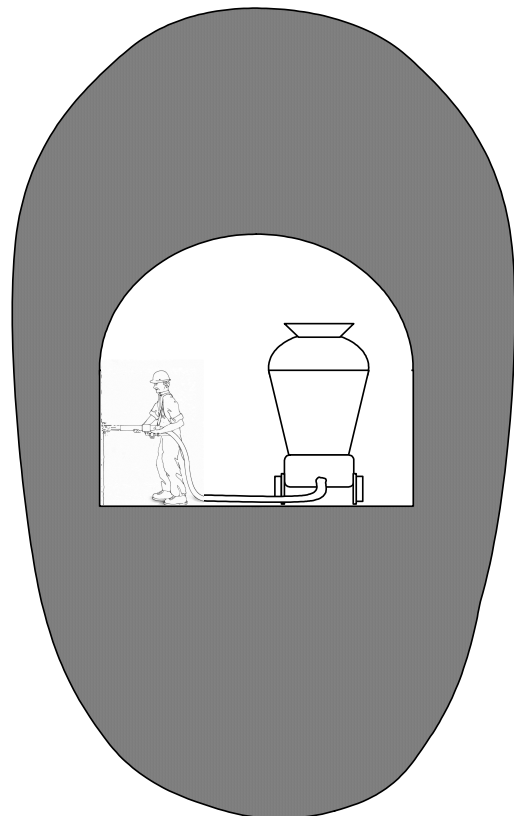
Работы пятого этапа (набрызгбетонирование выработки, закрепленной породобетоном)
